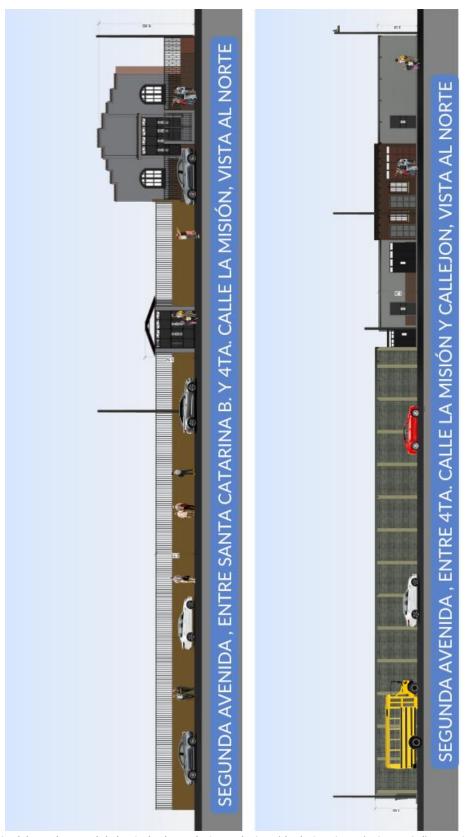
Elevación del estado actual de las fachadas en la Segunda Avenida de San Antonio Aguas Calientes, 2025.
